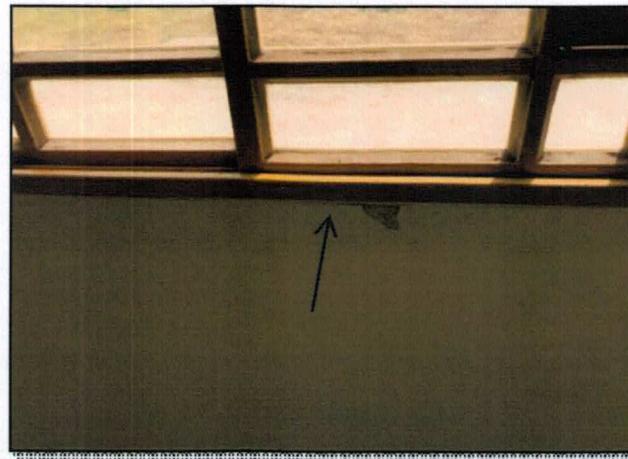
Foto da Parede: Fissura horizontal
